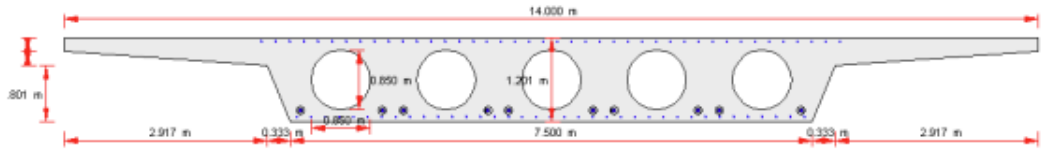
Sección tipo P.S. 14 m de ancho (PS 9.6)
